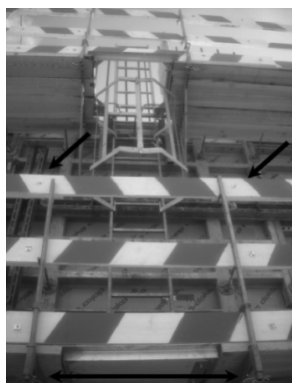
Ligações aparafusadas e encavilhadas nos guarda-corpos das plataformas de trabalho.
